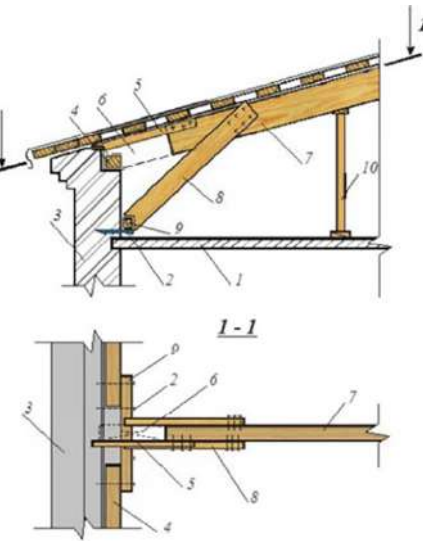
Усиление концов стропильных ног при помощи дополнительной балки [3]
